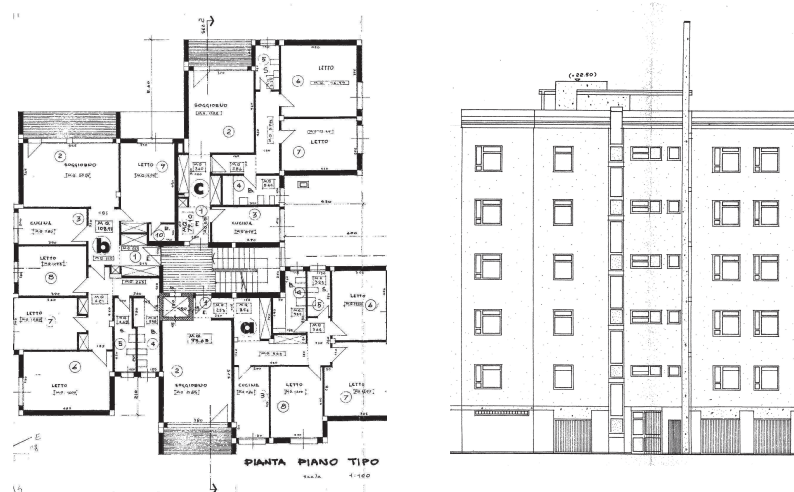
Pianta e prospetto dell'edificio oggetto di studio
